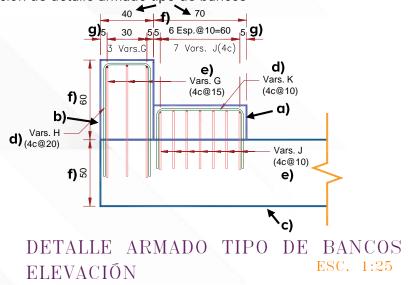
Ejemplo de elevación de detalle armado tipo de bancos
